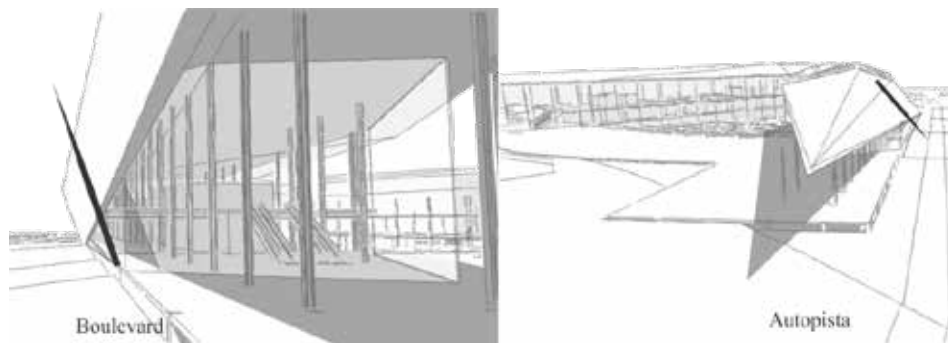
Comparativa de Planos Inclinados en Fachadas de la Edificación. (2016)
